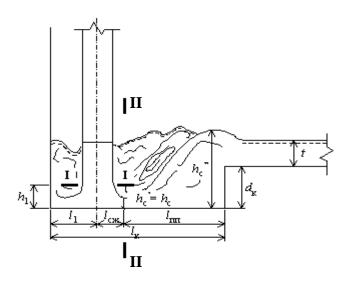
Схема к расчету прямоугольного водобойного колодца
